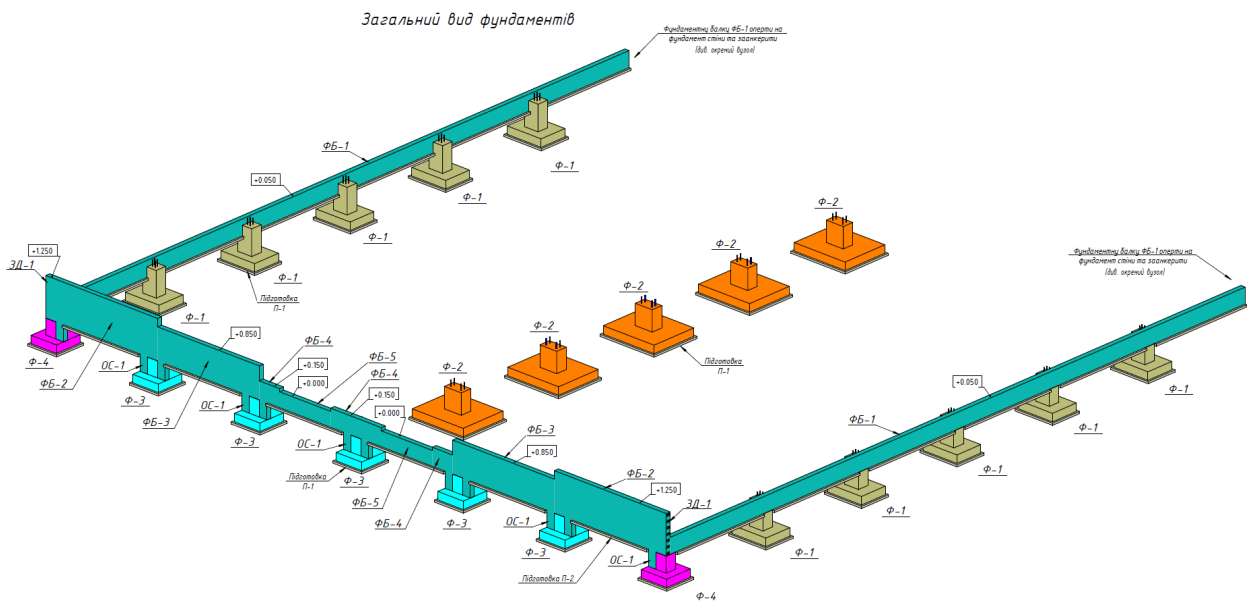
Фрагмент загального виду фундаментів неглибокого закладання з фундаментними балками.
